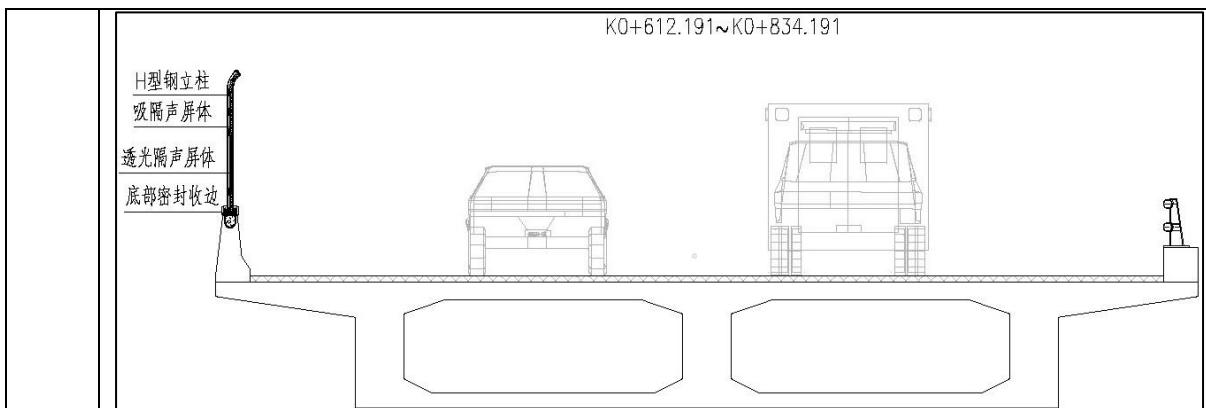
白鹤 2 号桥左侧直弧式声屏障安装横断面图
